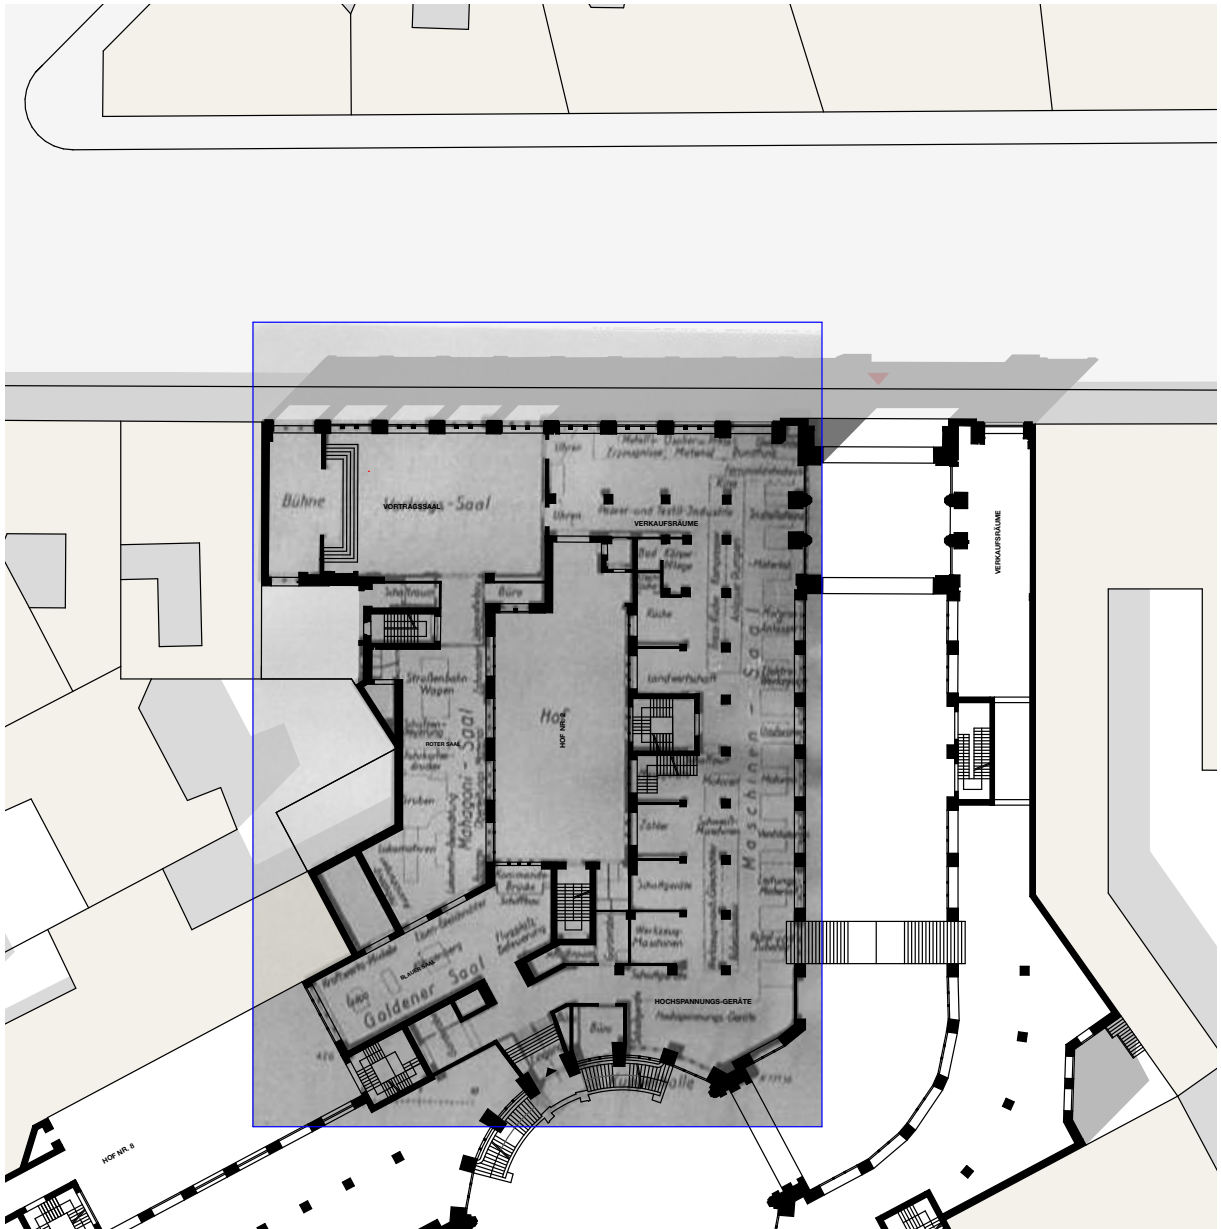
Grundriss Zwischengeschoss, Stand 1928 (maßstabslos)
